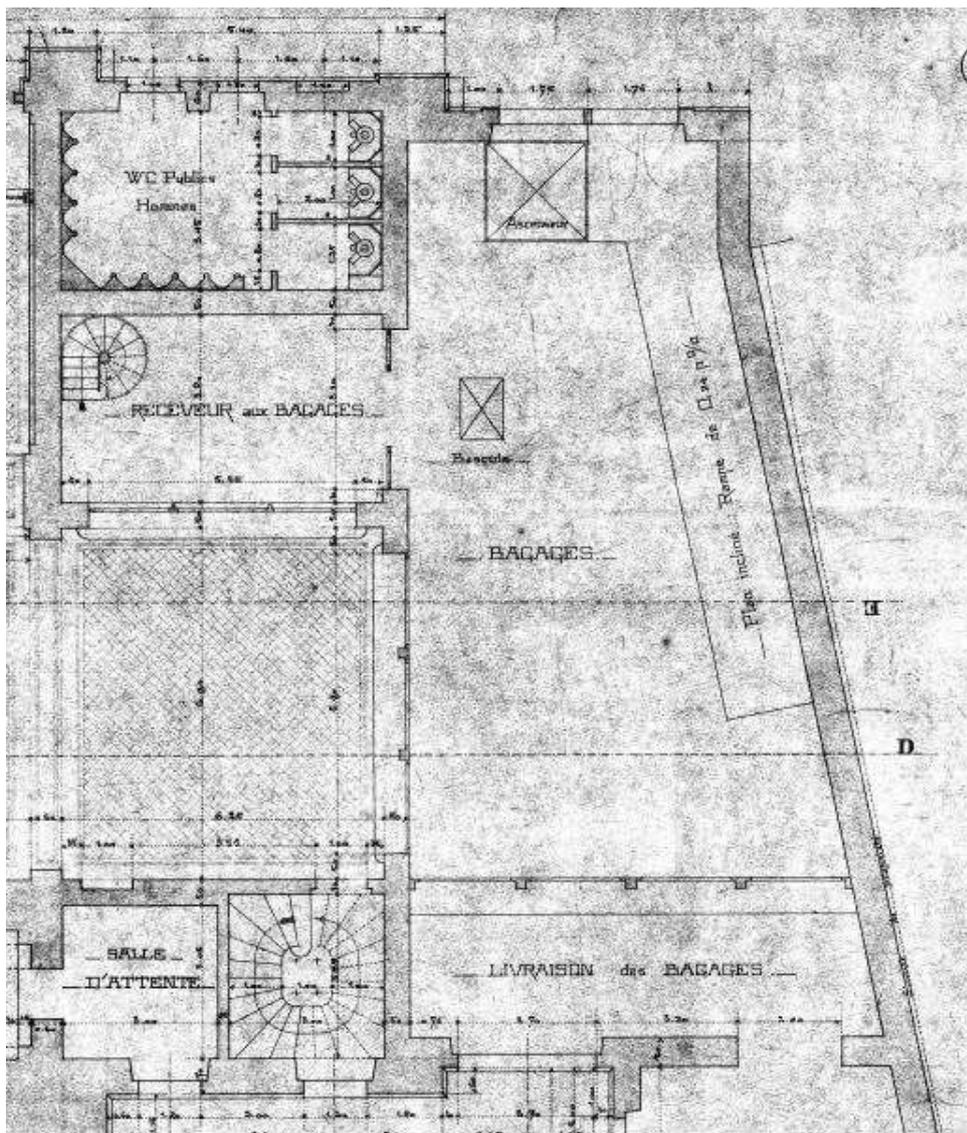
Local des bagages, plan du rez-de-chaussée (détail), Charles Coigny architecte, 13.8.1908 (CFF Lausanne Immobilier, SBB-IM-WEST 18000/101).
